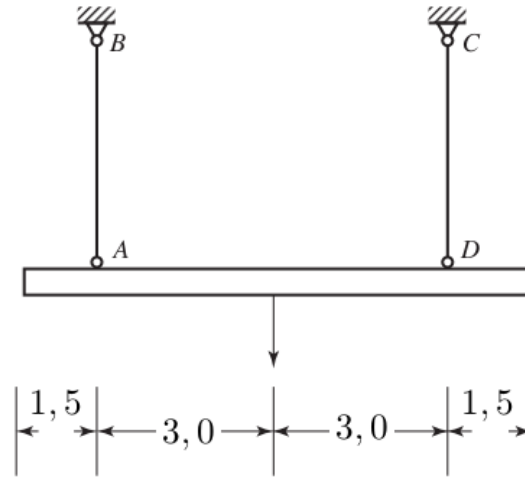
Perfil W suspenso por barras circulares maciças (em metros).
